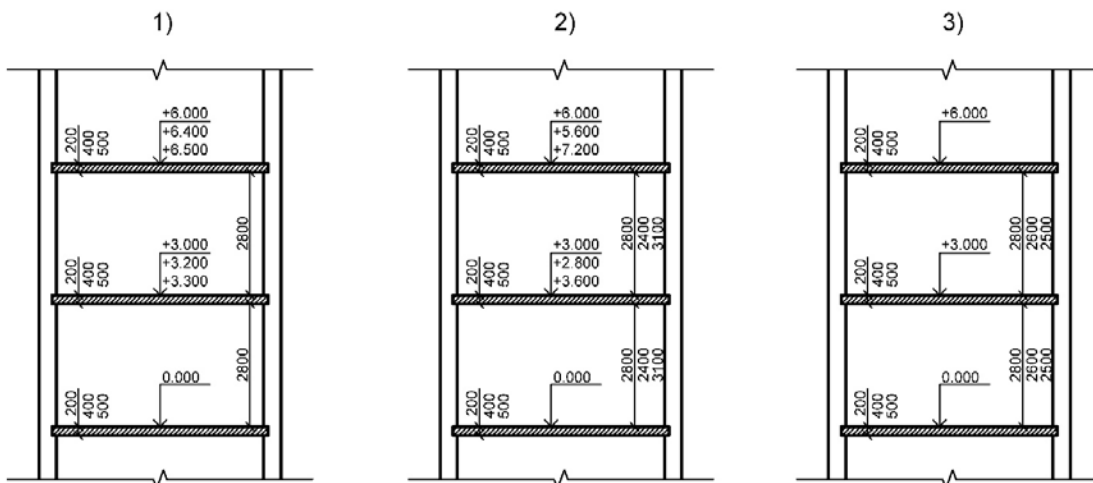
Варианты схем зданий с различными параметрами толщины перекрытия, высоты этажа и помещений:
